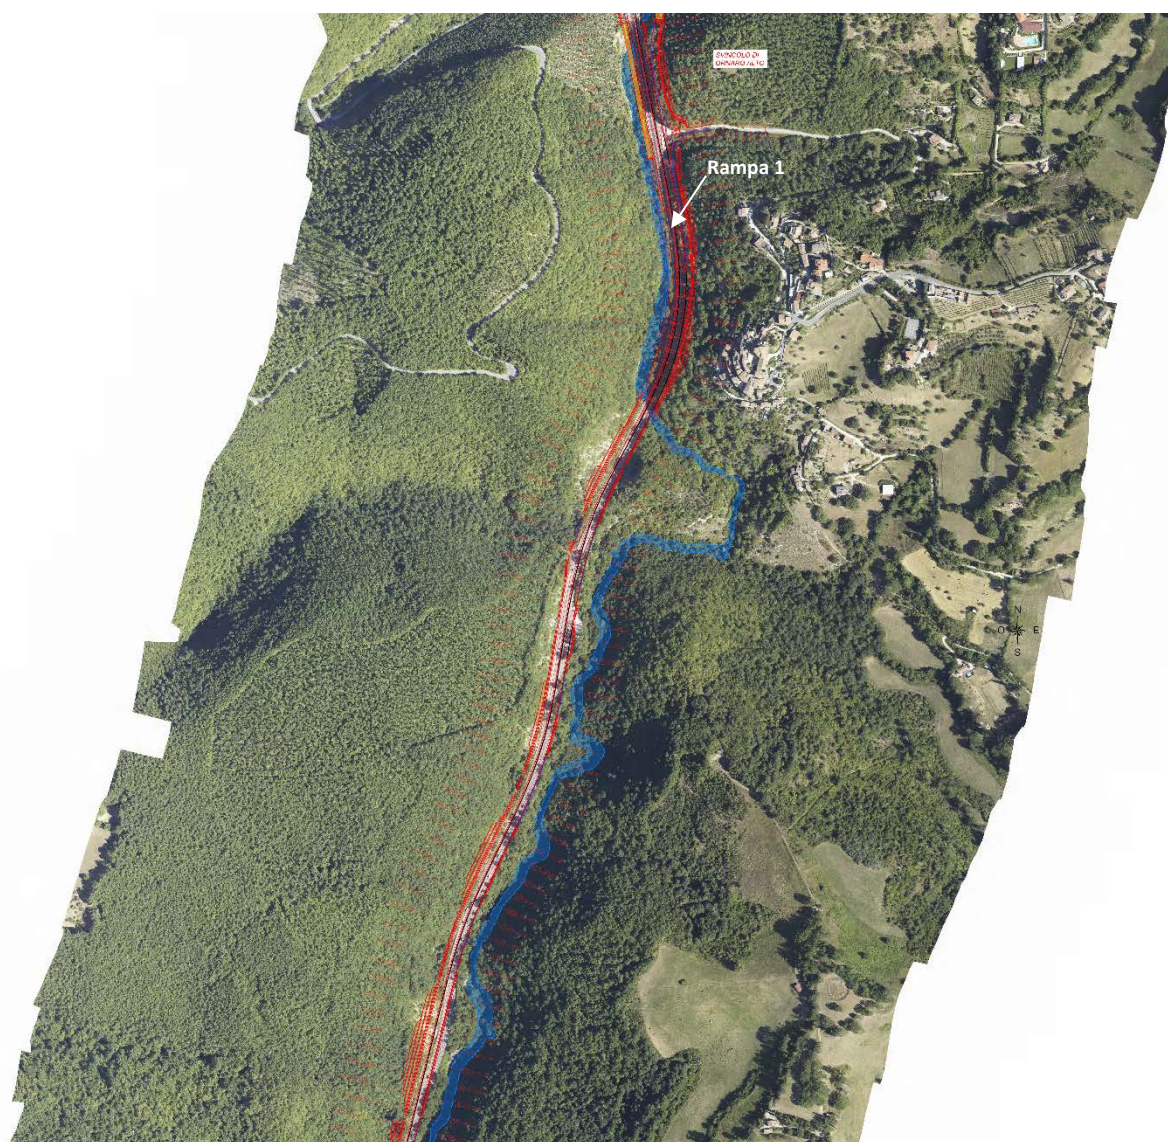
Lotto 1: tracciato di progetto su ortofoto dalla pk 4+800 alla pk 6+300
